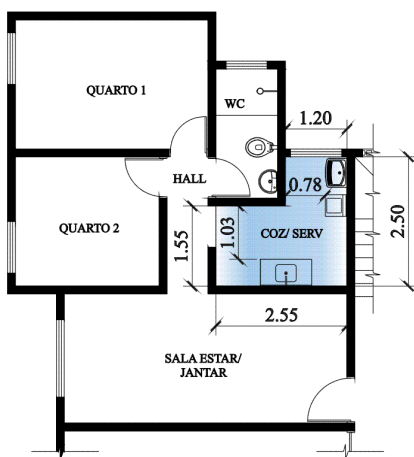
Planta Baixa Pav. Tipo: Setor de Serviço do Residencial Germano Santos (sem escala)
